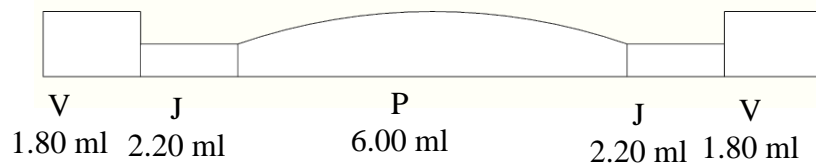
Sección vial Jr. Santa Justina. Elaboración propia
